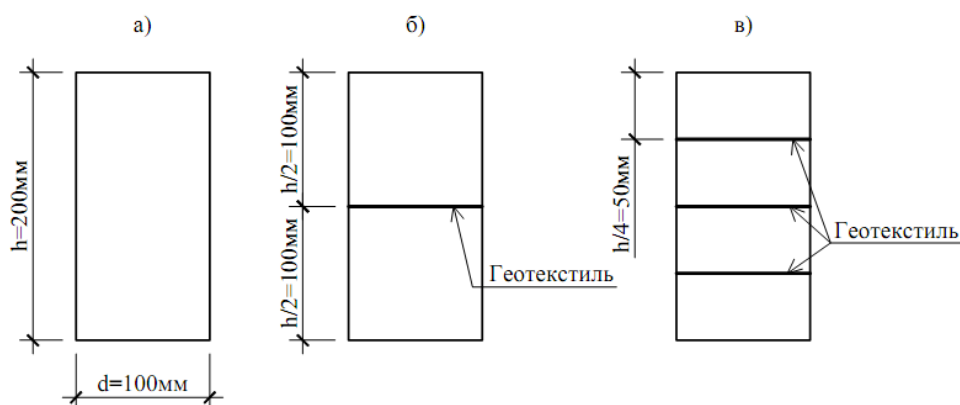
Расположение армирующего слоя в образцах: а) без армирования; б) с одним армирующим слоем; в) с тремя армирующими слоями.
